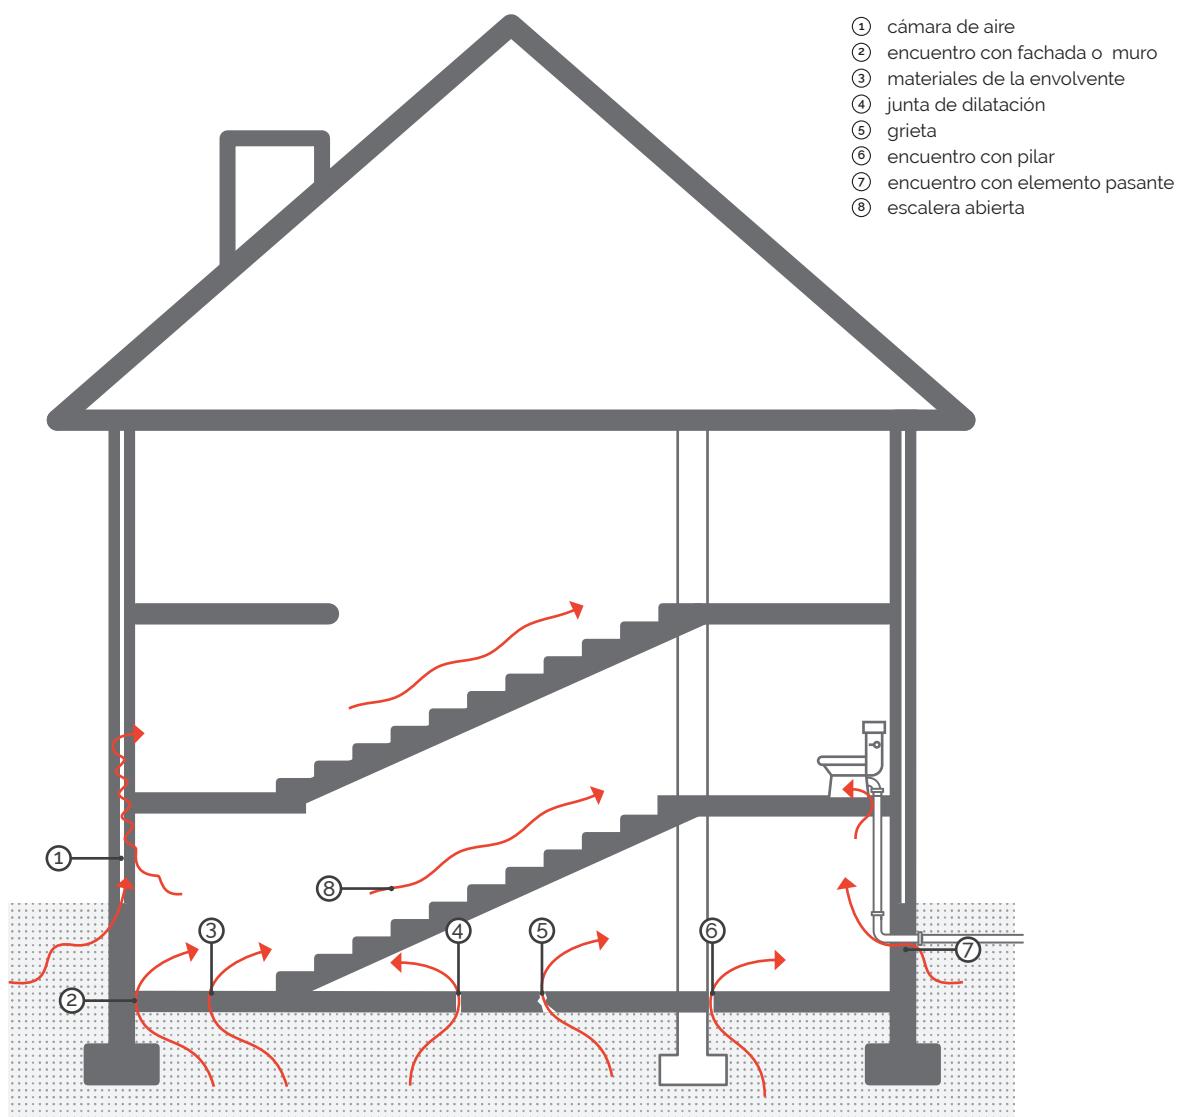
Vías más usuales de entrada de radón procedente del terreno y de comunicación con otras plantas
